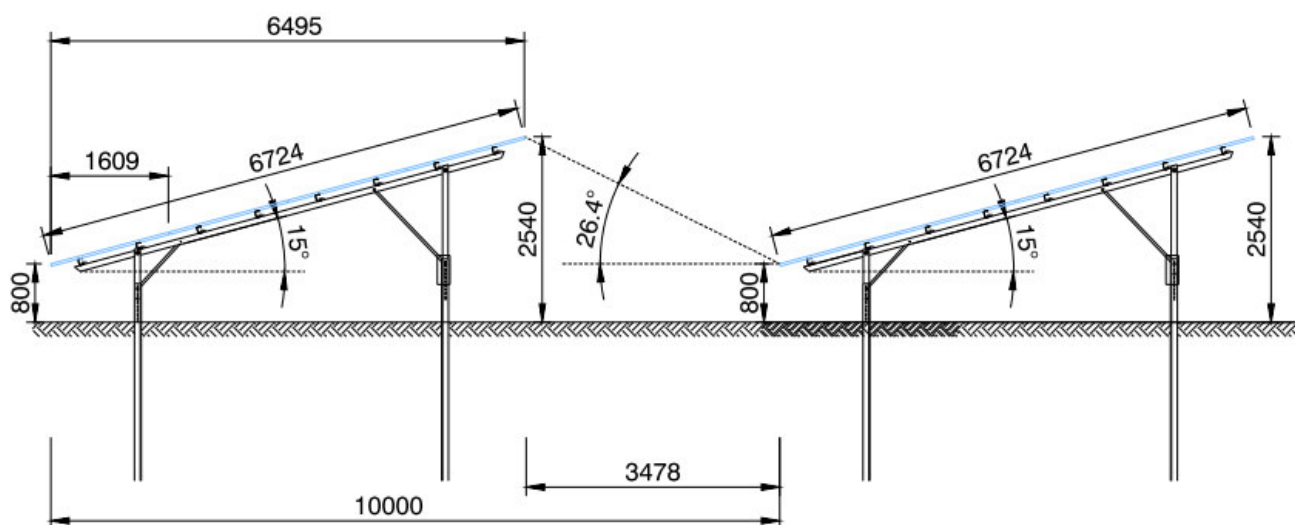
Skizze der Modulkonstruktion (Quelle: Planungsunterlagen)
